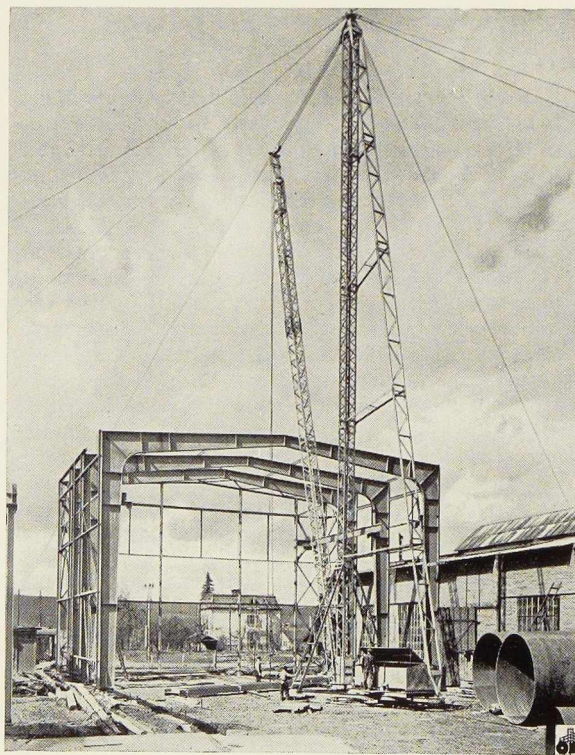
Charpente du nouveau hall de montage à la S. A. Conrad Zschokke à Doettingen (Suisse).
